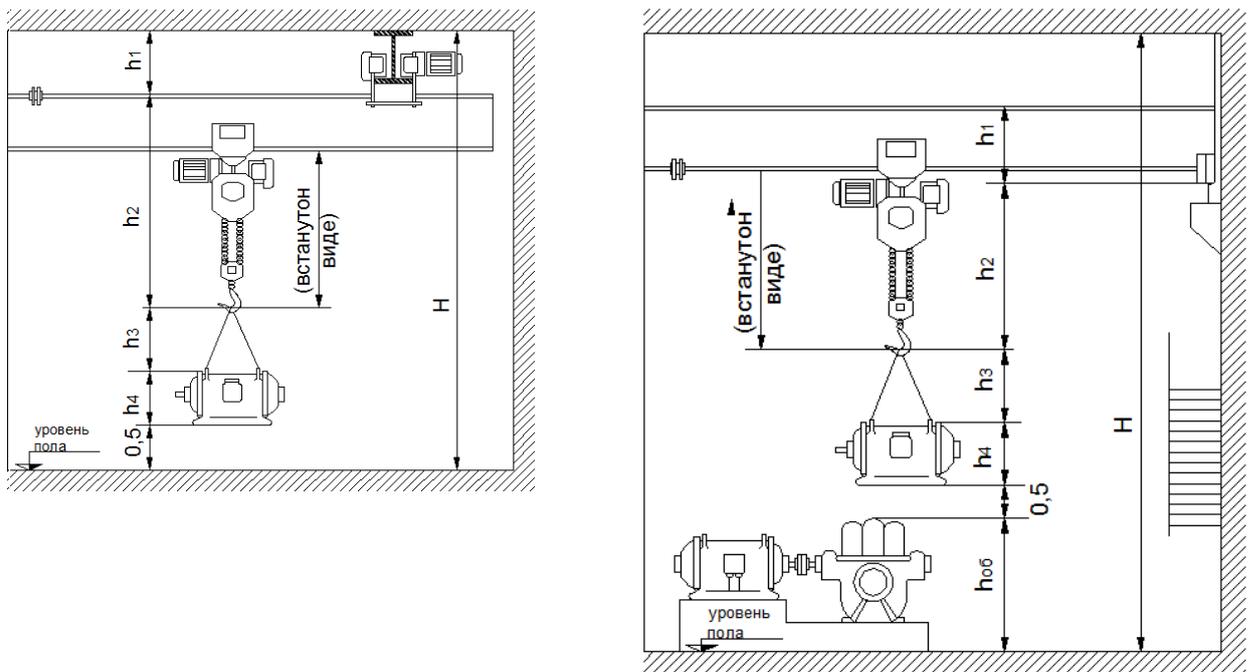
Схемы размещения грузоподъемного оборудования внутри помещения *Подземная часть насосной станции.* Подземная часть здания выполняется из фундаментных блоков из гидротехнического бетона, поскольку грунтовые воды находятся ниже отметки пола машинного зала. Наружную поверхность стен подземной части насосной станции покрывают битумной гидроизоляцией. Глубина подземной части назначается с учетом уровня воды в резервуаре чистой, допустимой высоты всасывания насосов, состава оборудования и рекомендаций, изложенных в справочнике монтажника (под ред. А.С. Москвитина). При строительстве станций применяют сборные конструкции. Высота балок, ригелей принимается порядка 0,1 от их пролета, а толщина плит перекрытий – 0,1-0,2 м.
